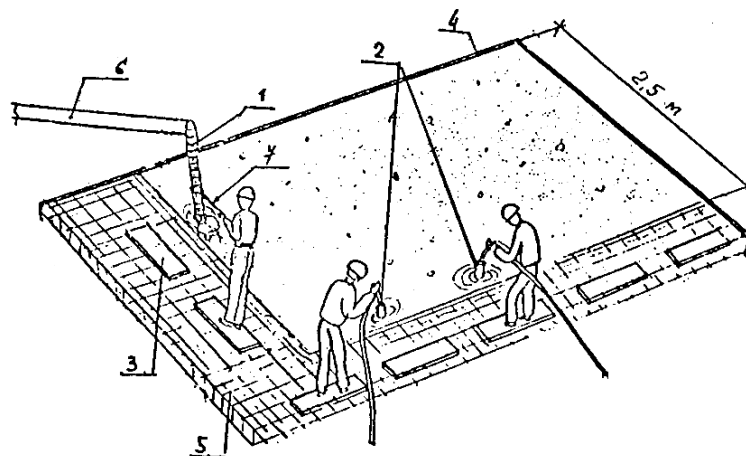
Схема организации рабочего места при бетонировании монолитной плиты
